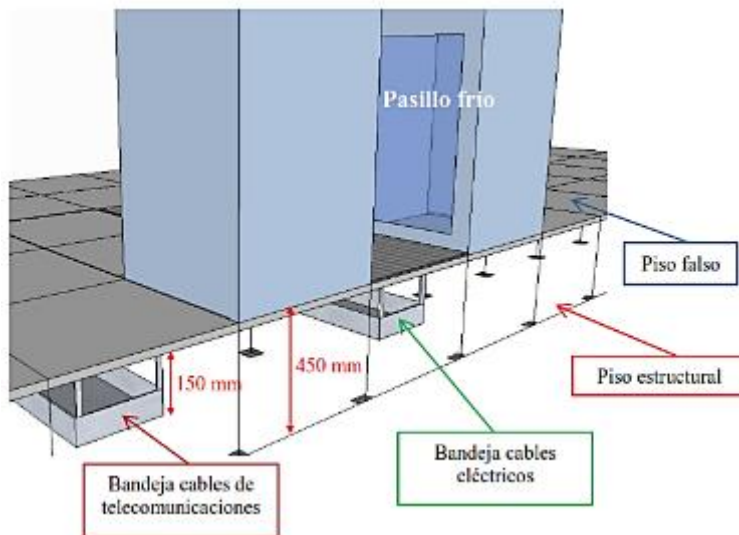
Ubicación de bandejas para cables bajo el piso técnico
